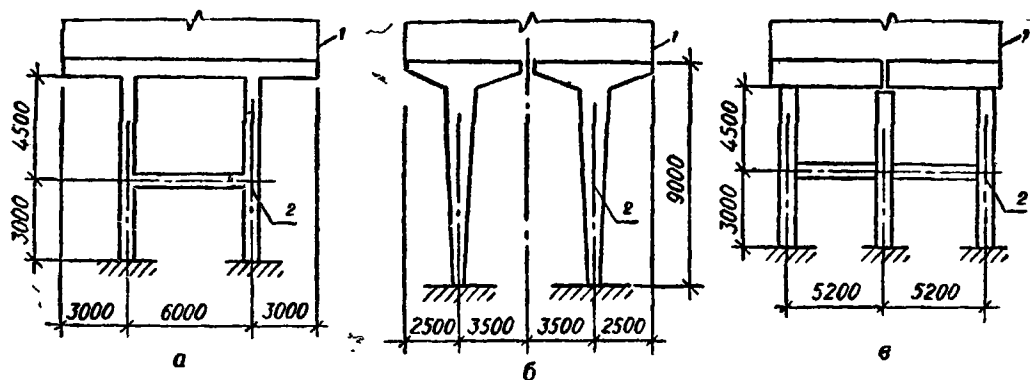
Конструктивні схеми каркасів перших поверхів у будівлях комбінованих систем: а — з двоколонних однопрольотних рам; б та в — з розрізних рам; 1 — габарит будівлі; 2 — каркаси перших поверхів
